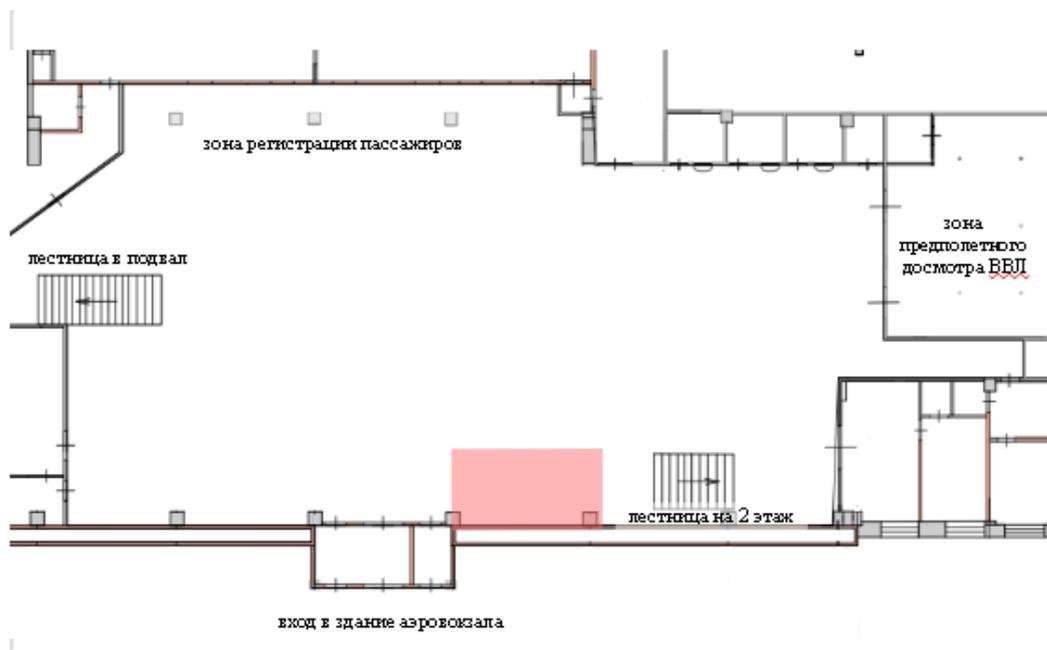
Схема размещения торговой точки на 2 этаже здания аэровокзала
